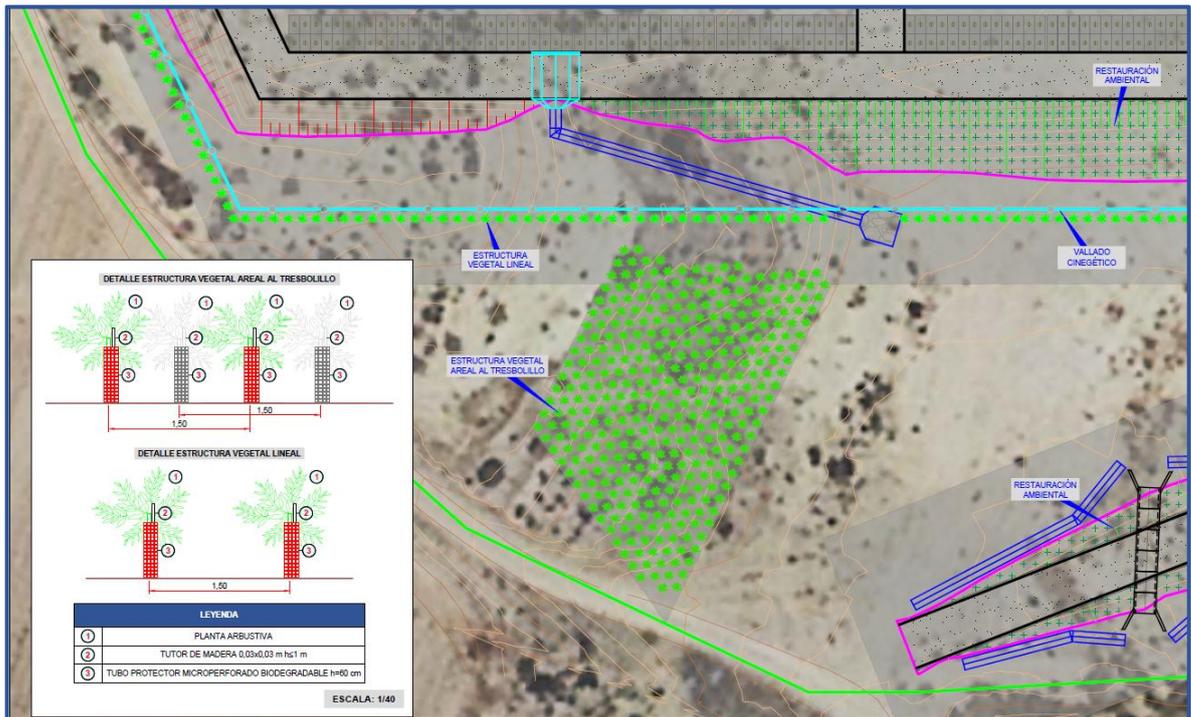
Zona de plantación areal en el entorno de la planta fotovoltaica.
